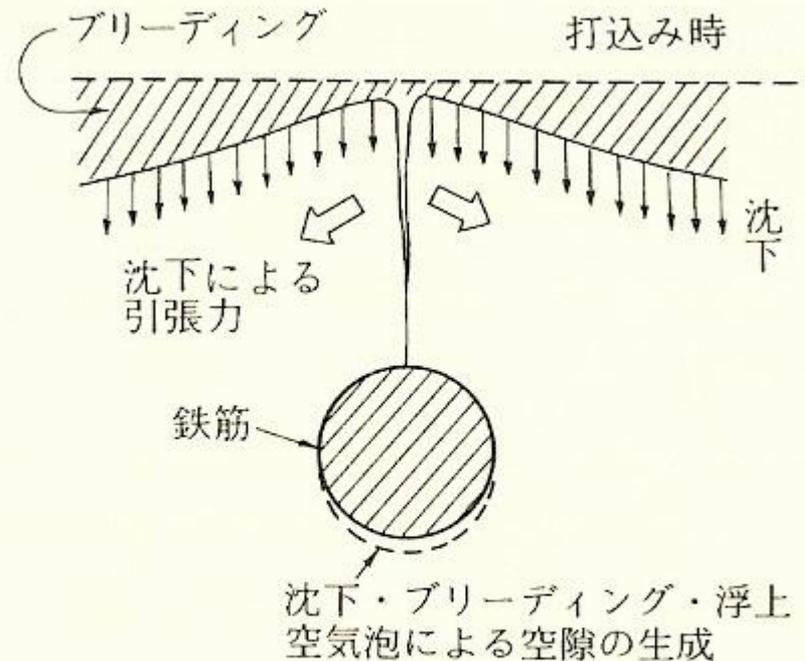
鉄筋上側に沿ったひび割れと鉄筋下側の空隙の生成
